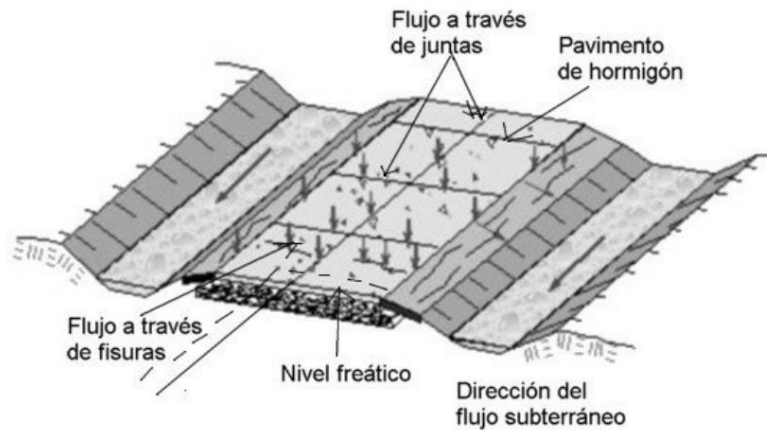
Forma en que escurre el agua sobre y bajo un pavimento de hormigón
